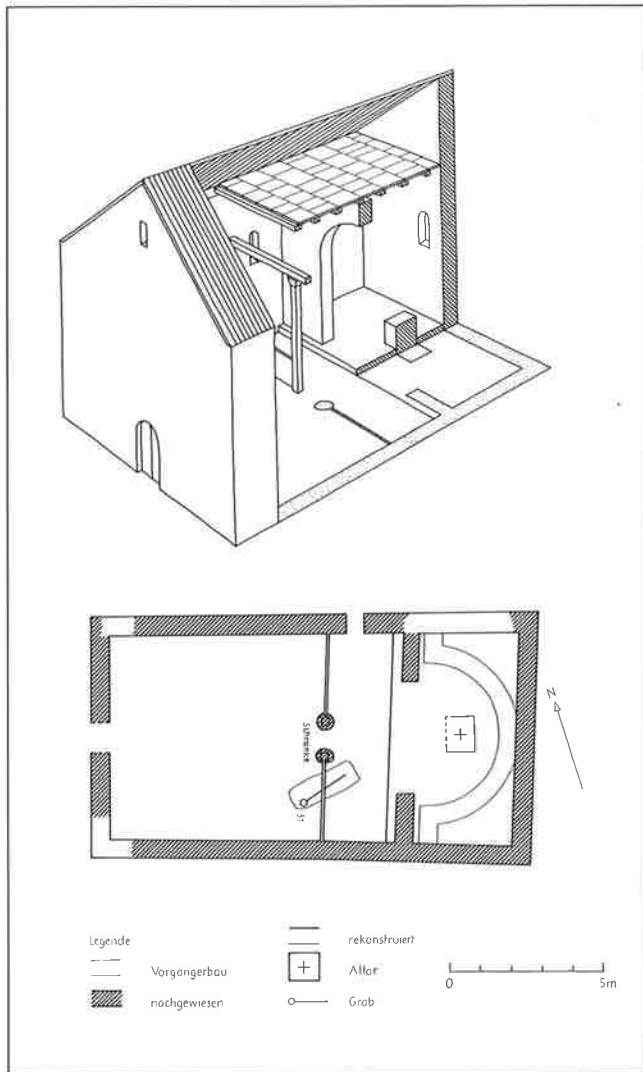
Stein am Rhein. Kirche Burg. Grundriss und Rekonstruktion der Rechteckkirche (Bau III.1). M 1:250.
